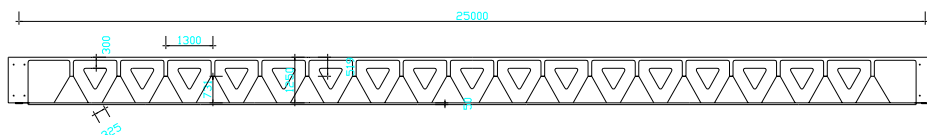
Coupe longitudinale - solution 25 m - Dalle BFUP treillis et matériau composite
